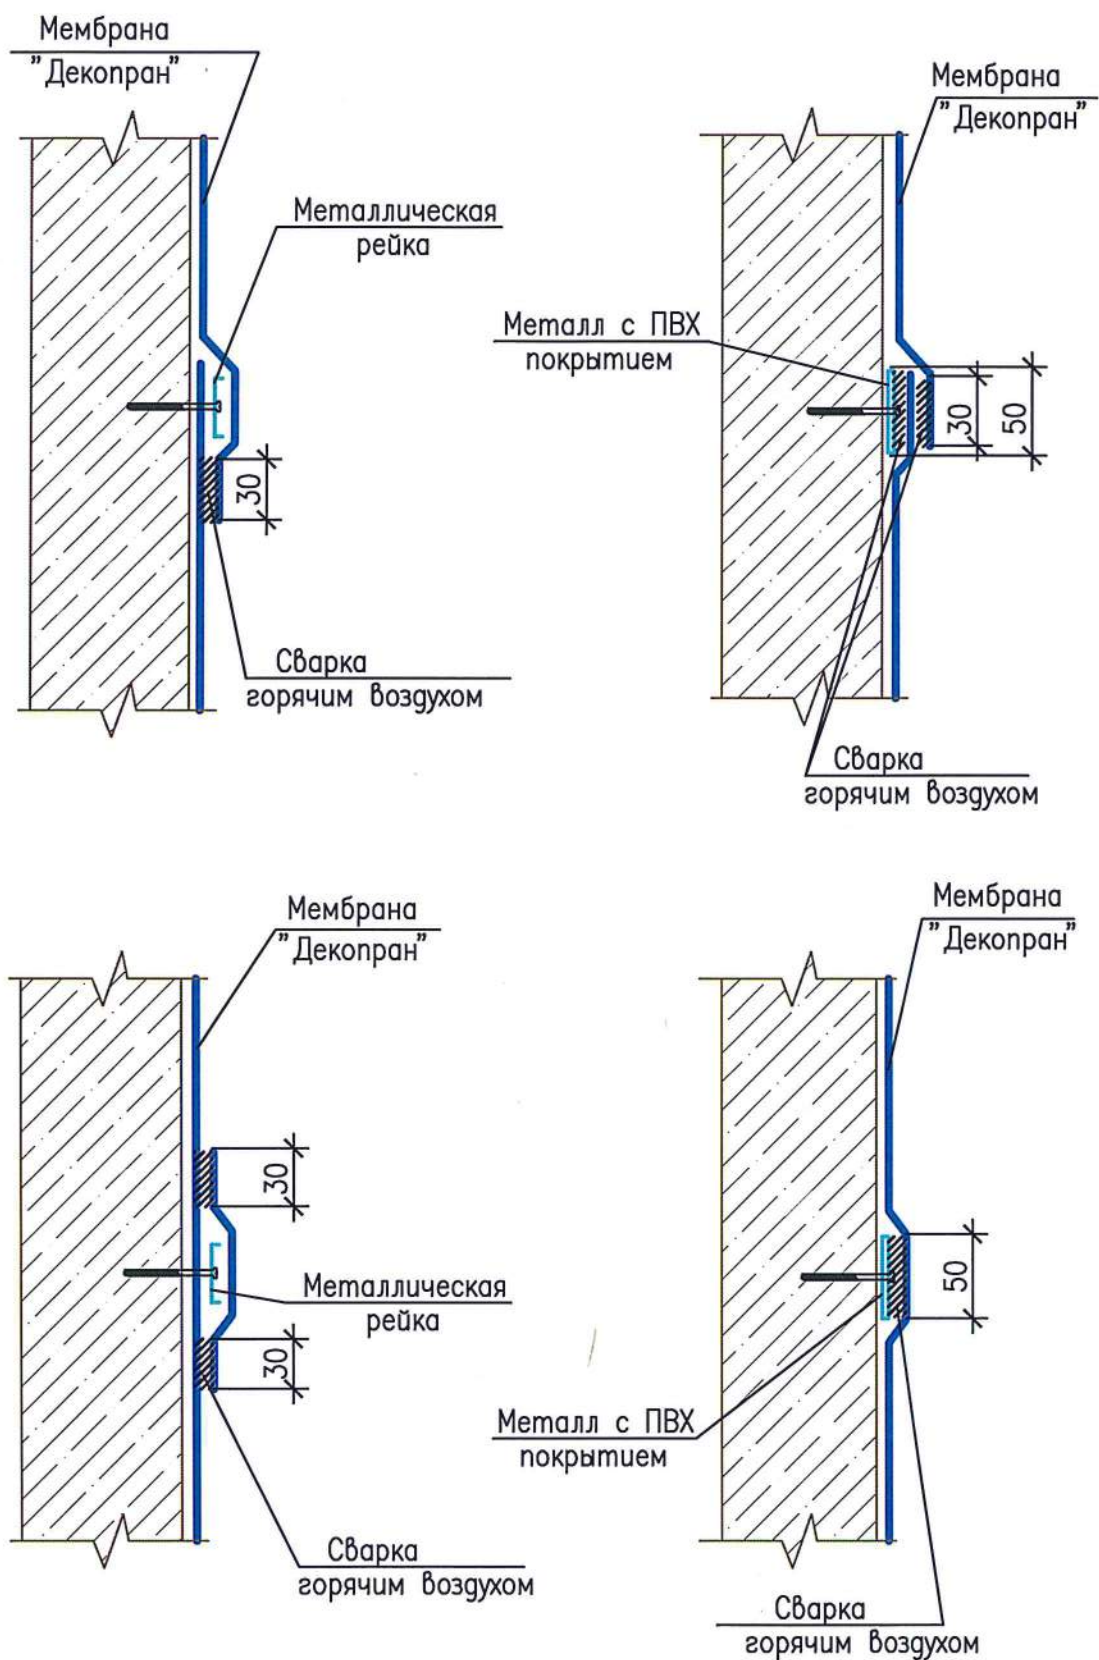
Механическое закрепление к железобетонному основанию. Варианты устройства дополнительного крепления мембраны при высоте примыкания больше 0,5 м
